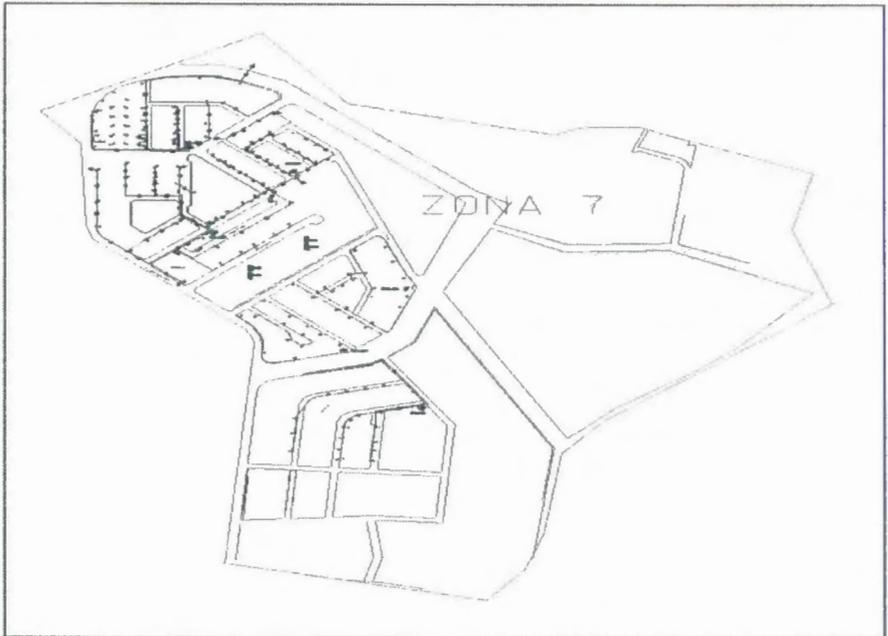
Planimetría zona 7 del sector de la vía a Daule
